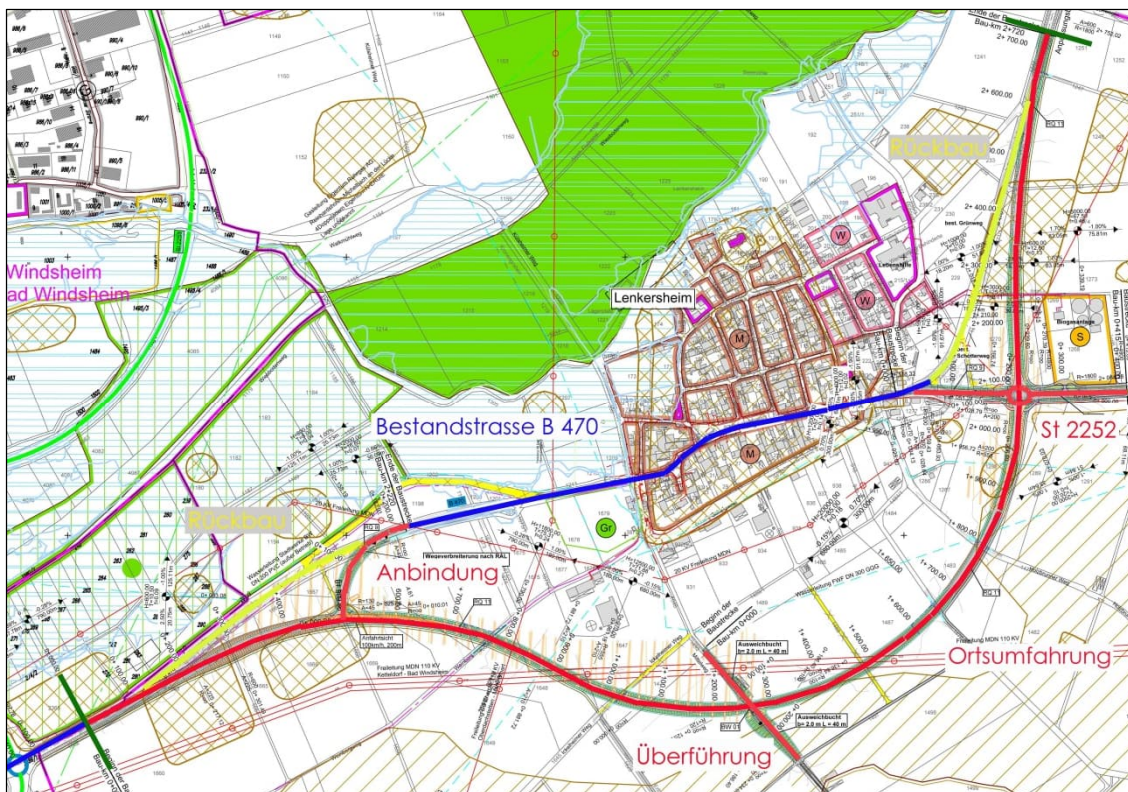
Lageplan mit Darstellung der geplanten Ortsumfahrung von Lenkersheim /11/
